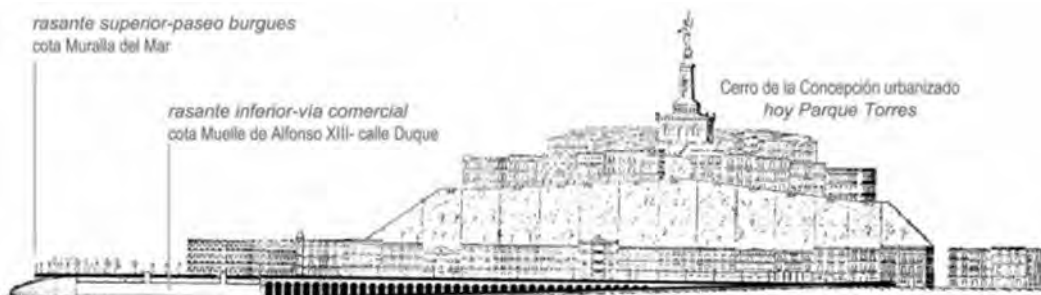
Proyecto para la calle Gisbert con doble rasante REVISTA DE OBRAS PUBLICAS, Número 1164; 1898 (Martínez Hidalgo)
